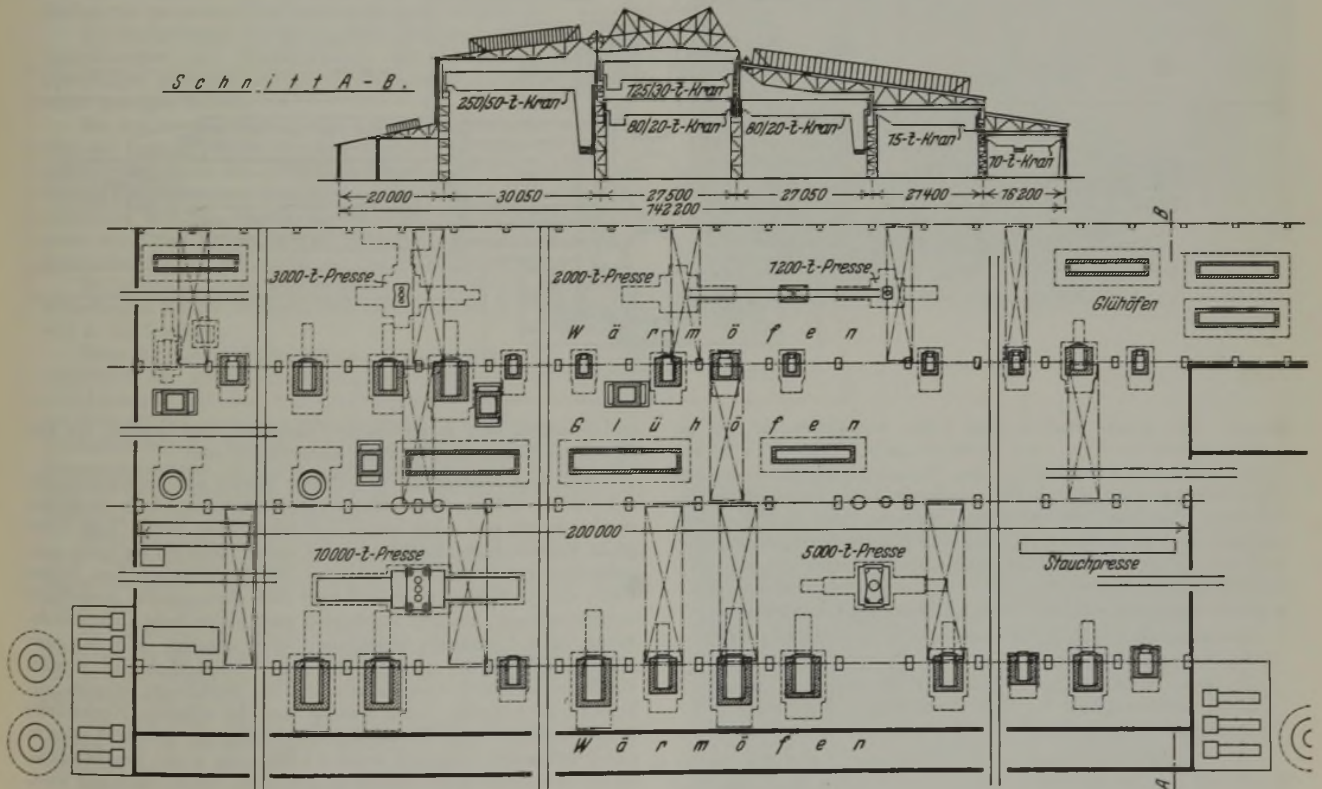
Grundriß und Aufriß des Preßwerks.
